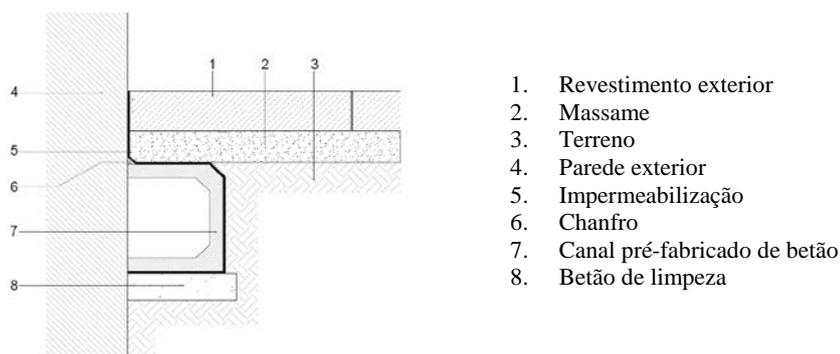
Pormenor do sistema de ventilação da base das paredes a implementar no exterior das fachadas norte e este do edifício.
